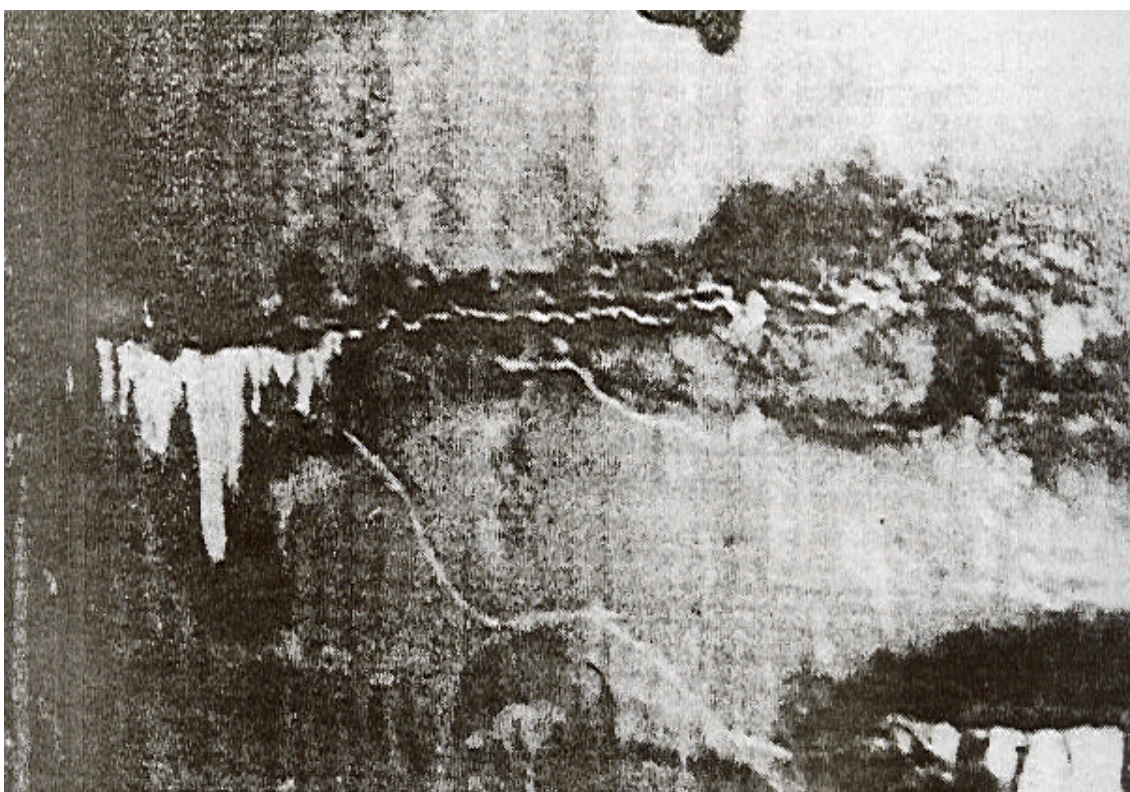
Exsudação de gel da RAA em fissuras de expansão- Obra no Brasil.
